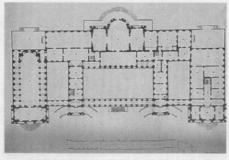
Planta del teatro Alejandro, en Tsarkoie Tseló Fig. 8. Fachada principal del Instituto Smolni (1806-1808)
